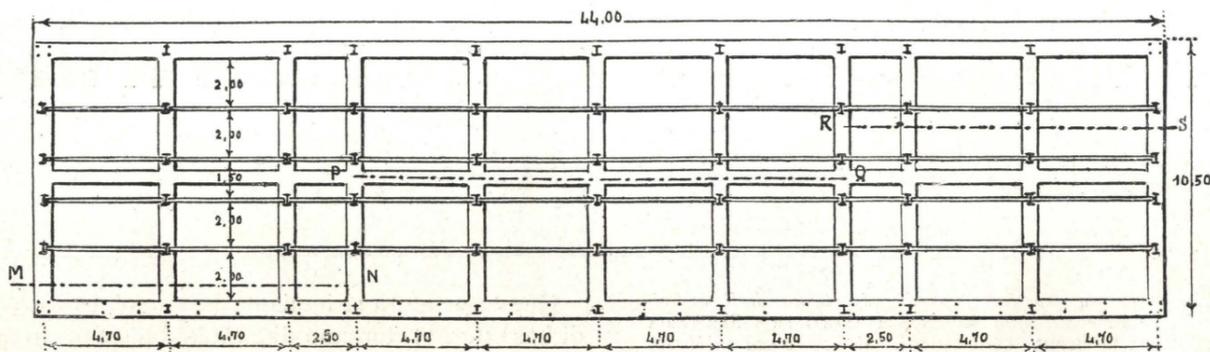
Posizione dei montanti di ferro nel telaio di fondazione e travatura del solaio del tipo come sopra.
